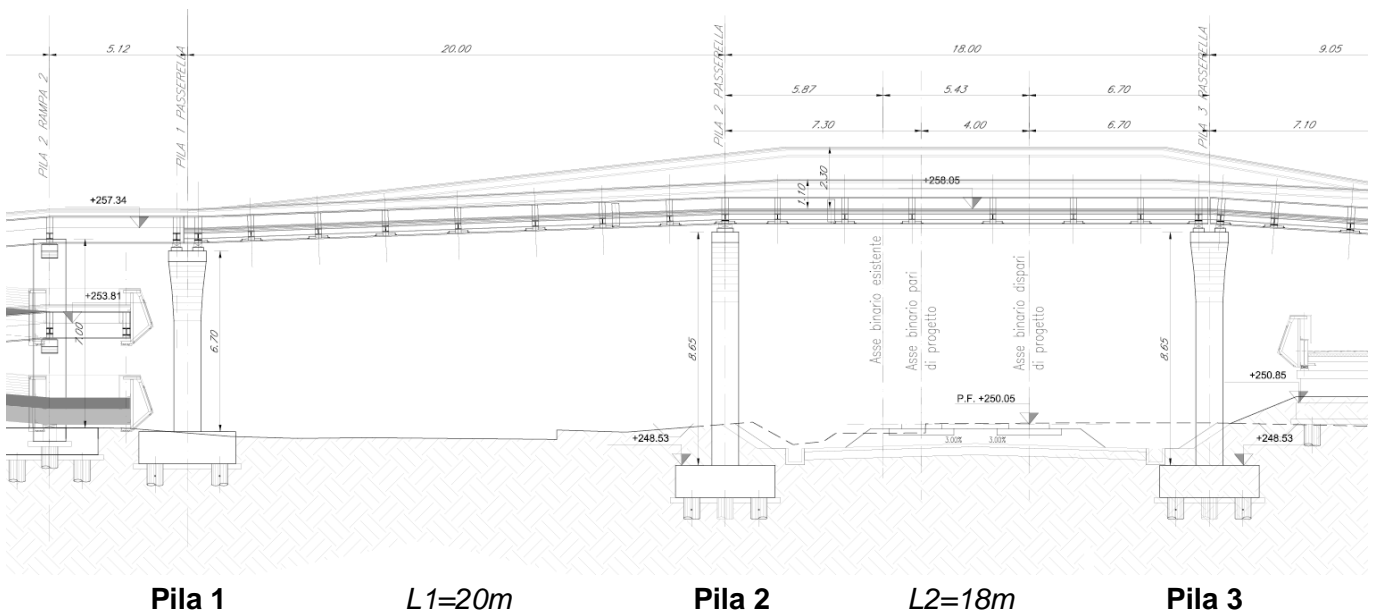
Stazione Vigna di Valle – Sezione longitudinale attraversamento
